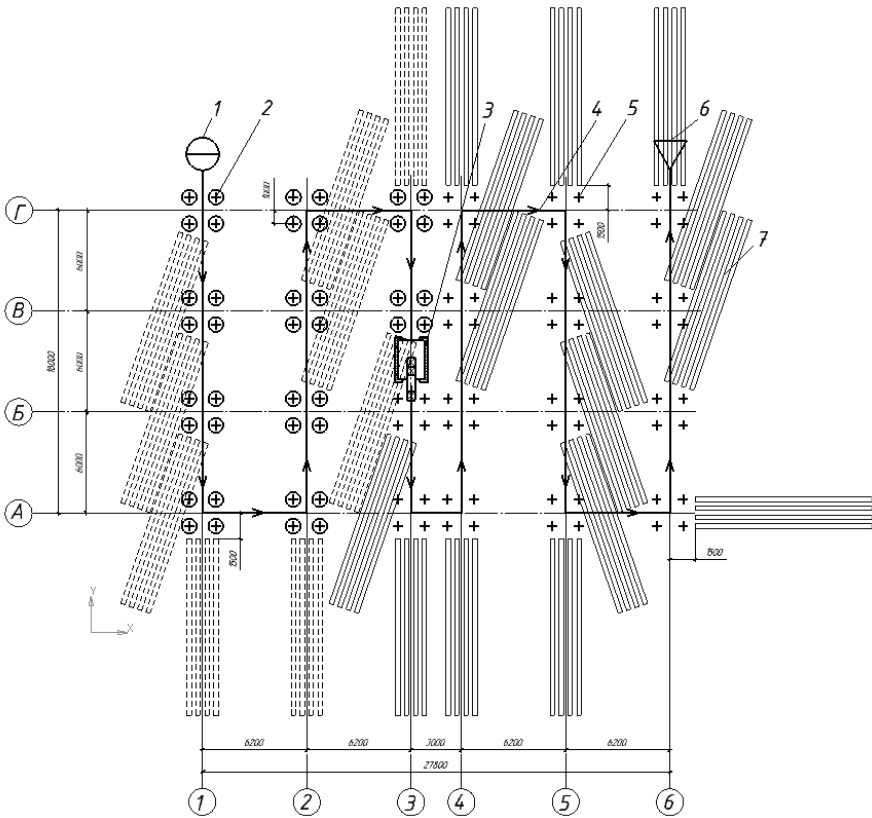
Технологічна схема забивання паль палебійним агрегатом: 1 – початок руху палебійного агрегату; 2 – забита паля; 3 – палебійний агрегат; 4 – напрям руху палебійного агрегату; 5 – місце для забивання палі; 6 – кінець руху палебійного агрегату; 7 – паля.
